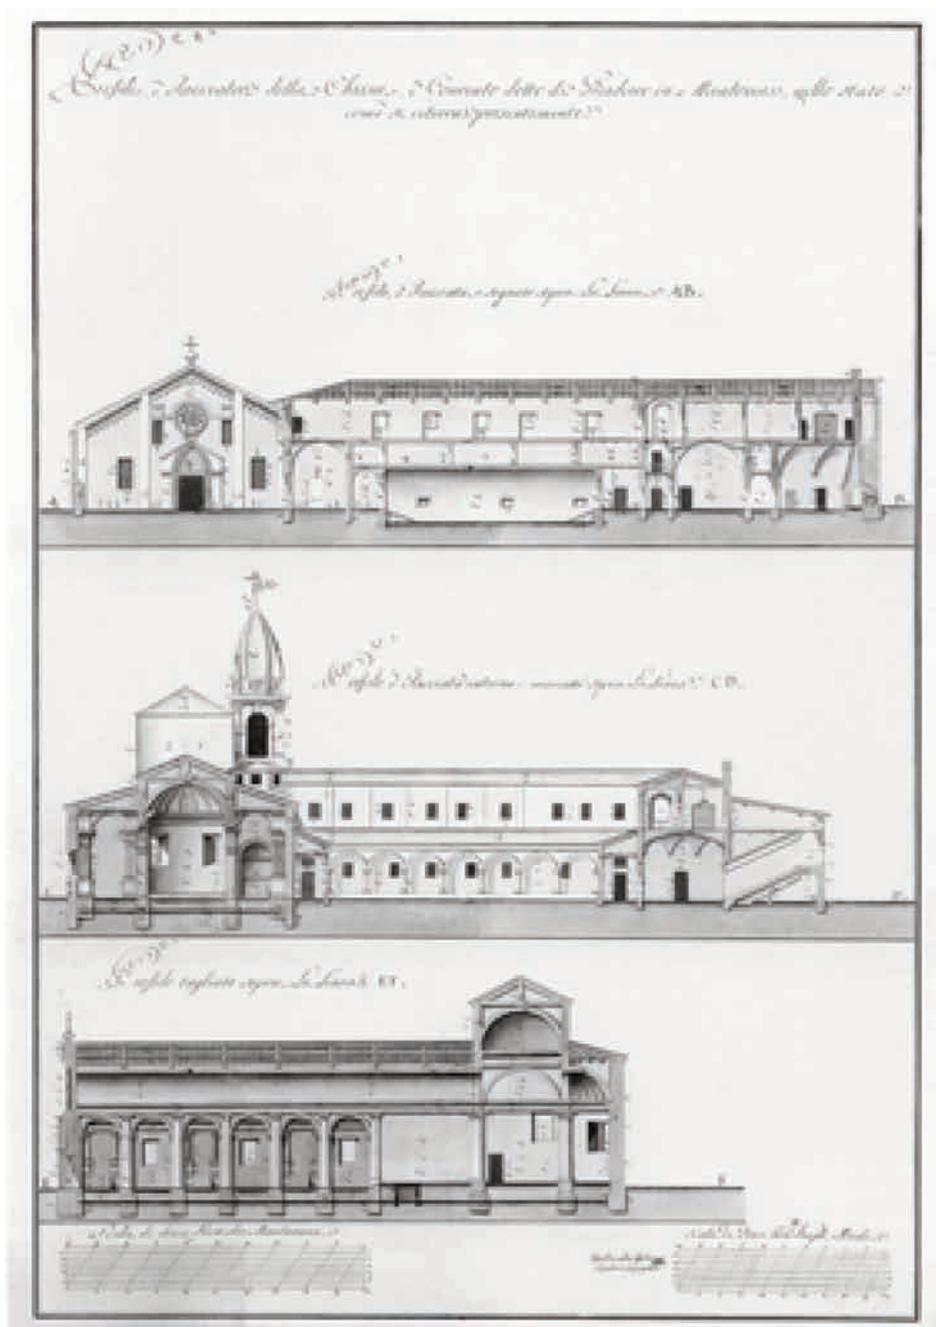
Profili e Facciata della Chiesa e Convento detto di Gradaro in Mantova nello stato come si ritrova presentemente, Gaetano de John, 1778 (KAW, Karten- und Plansammlung, GVII D 27 b).
